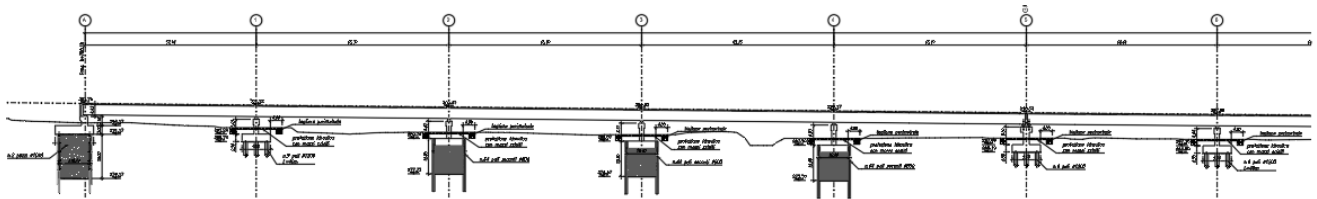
Sezione longitudinale carreggiata direzione Grosseto
